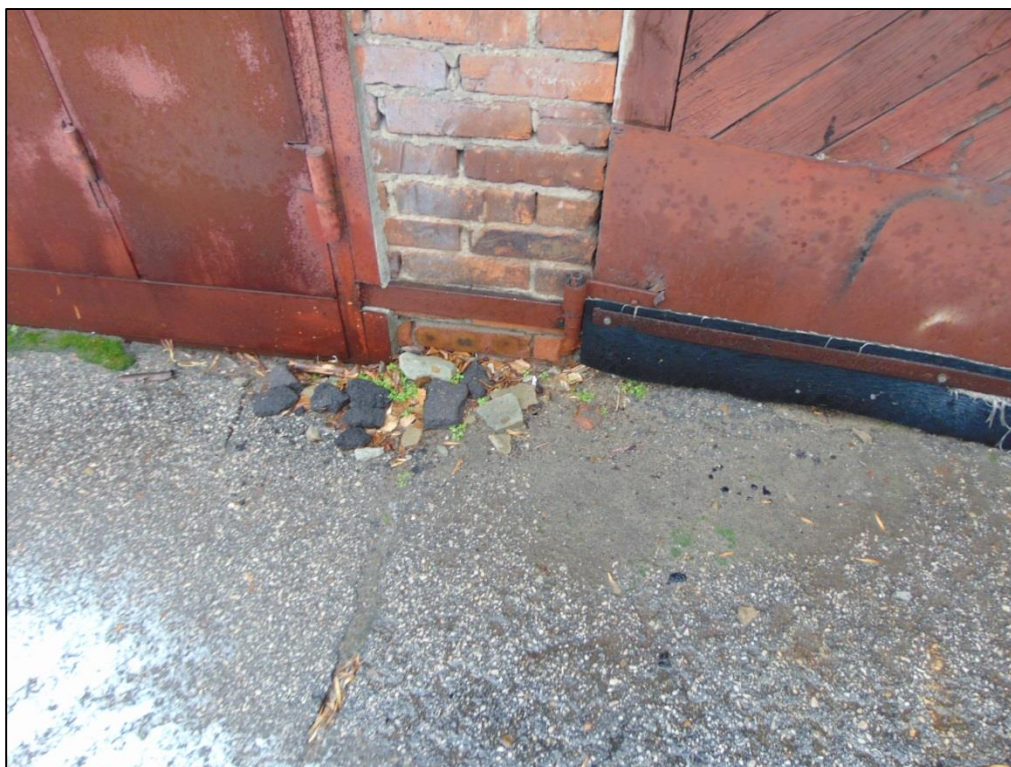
Цокольная часть наружных стен бокса. Признаков разрушений и деформаций конструкции фундаментов не выявлено.
